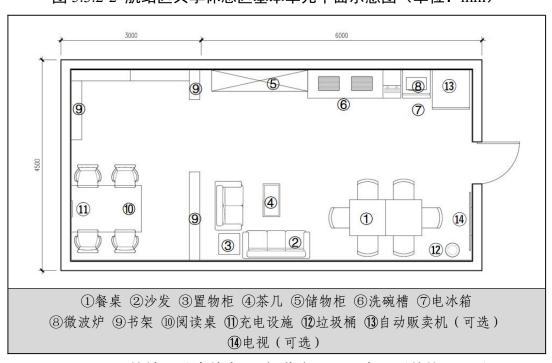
航站区共享休息区+阅览室平面示意图(单位: mm)
